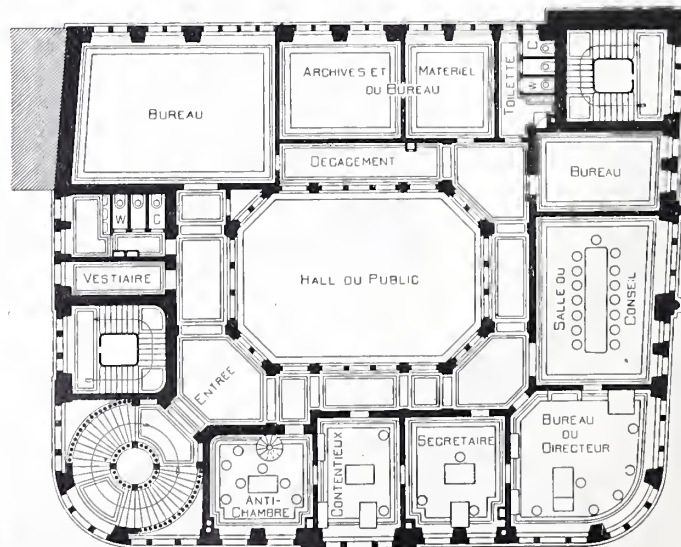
Plan du rez-de-chaussée de la Banque de l'Etat de Fribourg.
